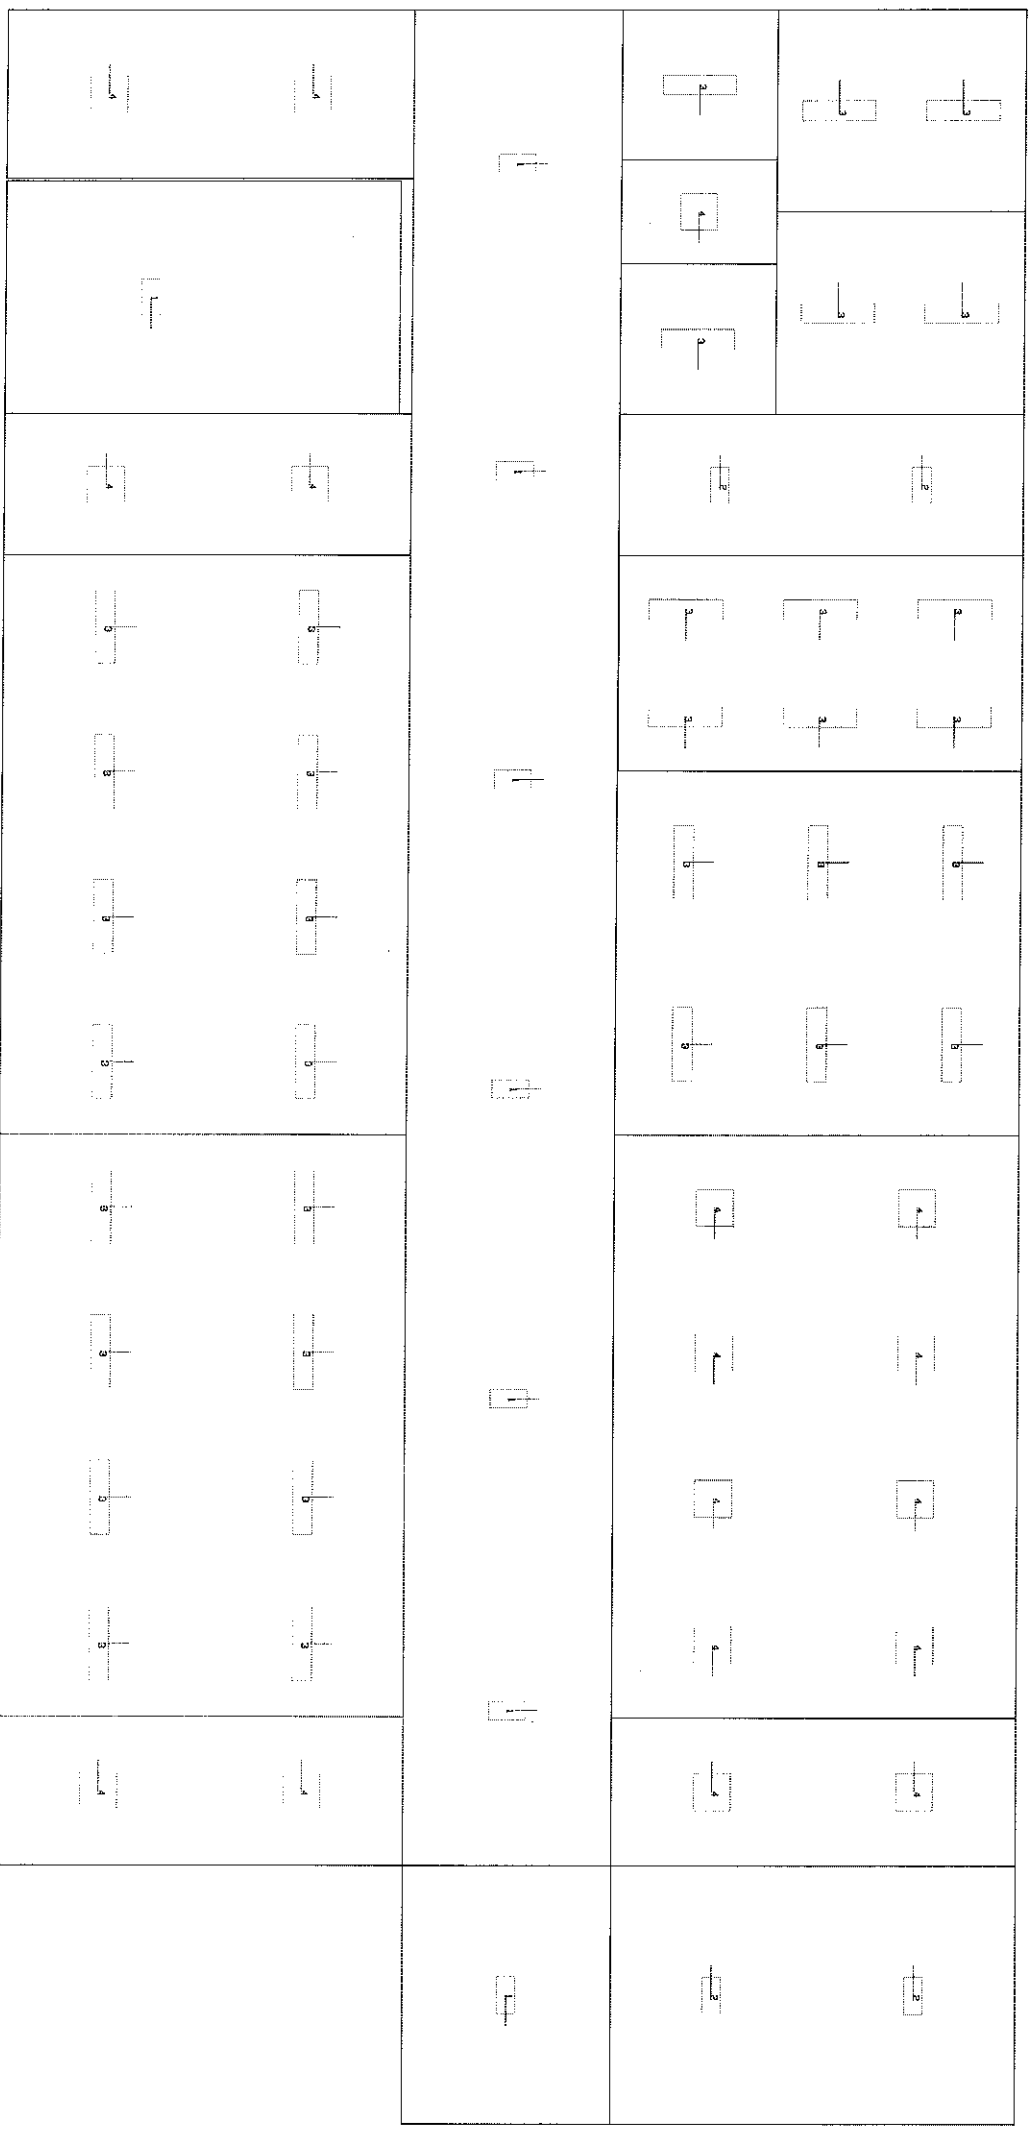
Plan Instalacji Oświetleniowej – Zespół Szkół w Drobinie – Segment C – Parter
